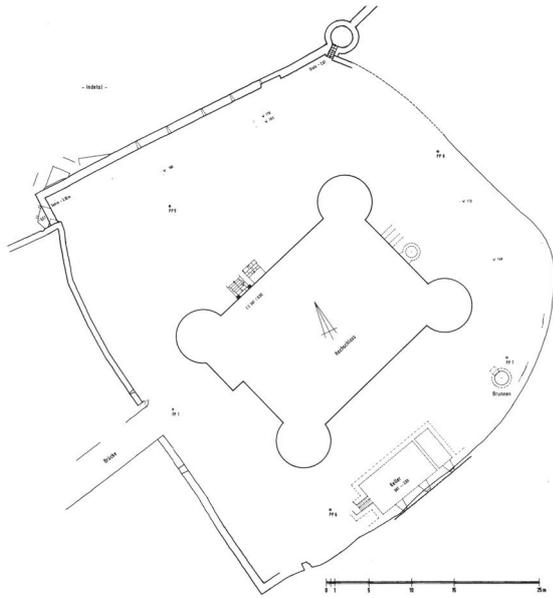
Grundplan der Burg Nothberg mit Bering und Palasbau.
